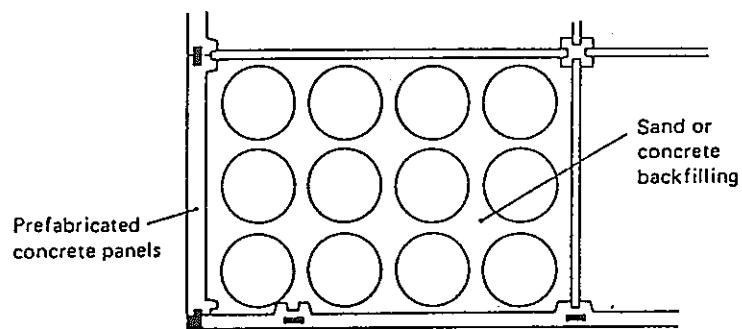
コンクリート壁トレンチの平面図 (IAEA, 1985)
